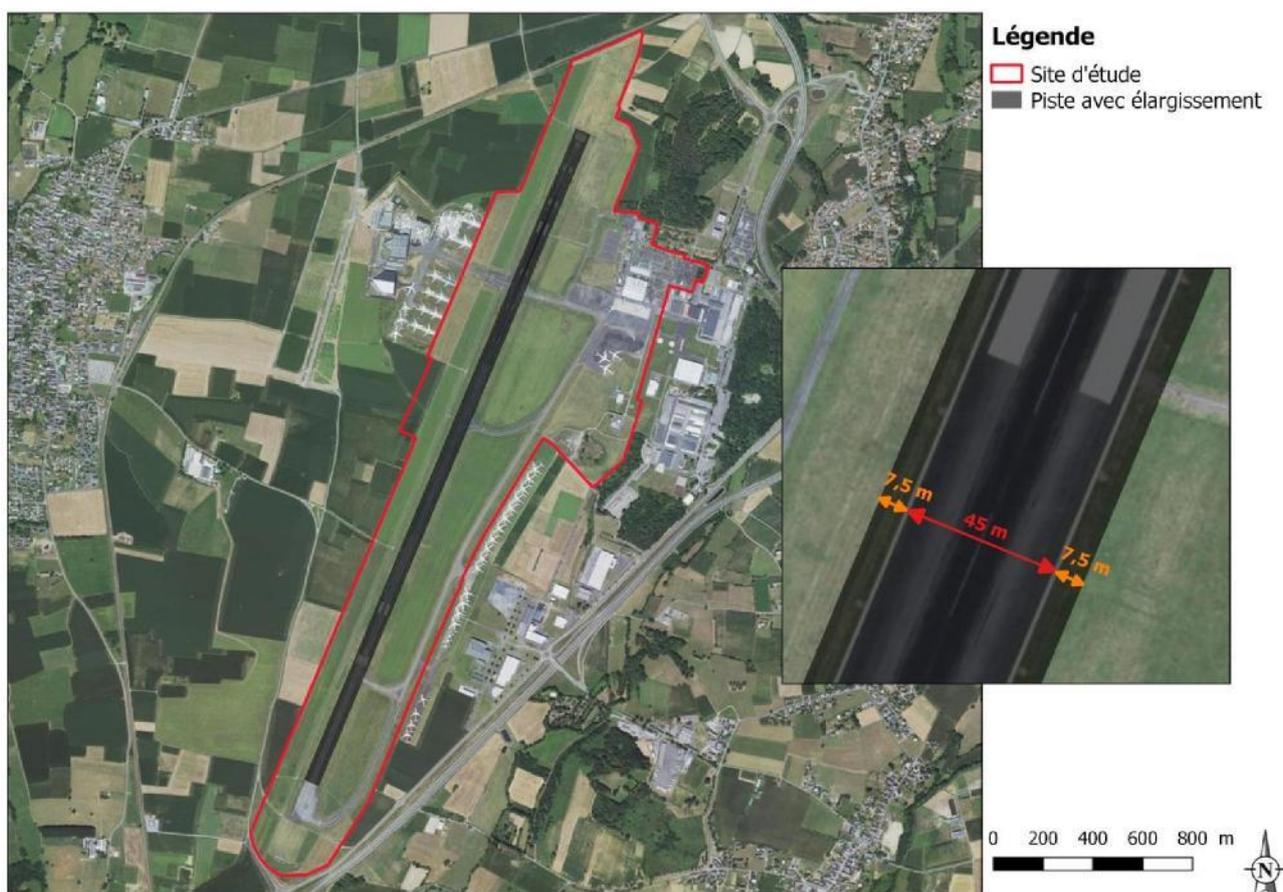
Projet réfection piste d'atterrissage (fond de plan : IGN)
